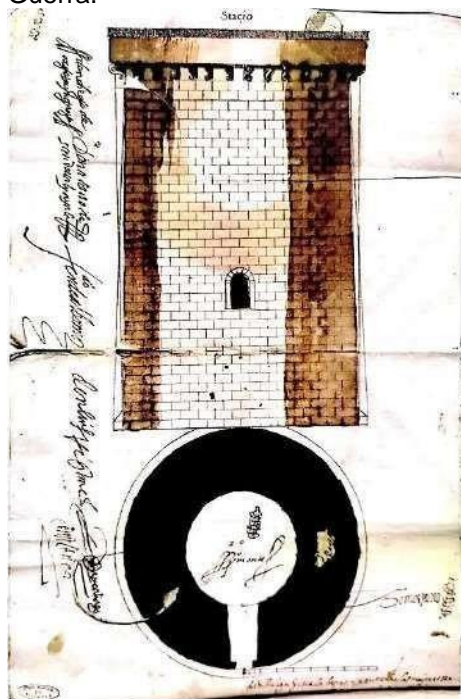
Planta y alzado de la torre del Estacio, (Archivo Municipal de Murcia, 1591)
